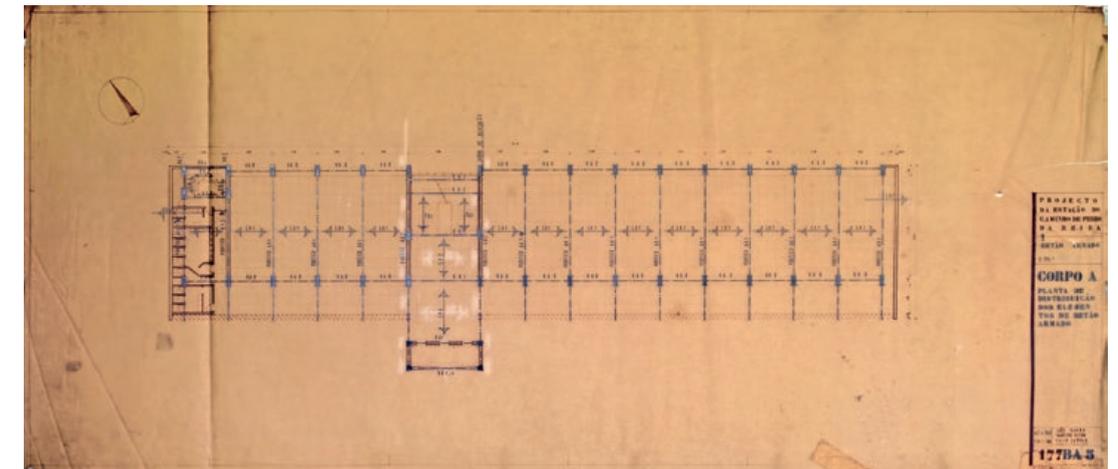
Marcelo Moreno Ferreira, Estação Central da Beira / Beira Central Station (1957-1966), Projeto de Betão Armado, Corpo A, Planta de distribuição de elementos de betão armado / Reinforced Concrete Project Body A, Distribution of reinforced concrete elements (1960)
